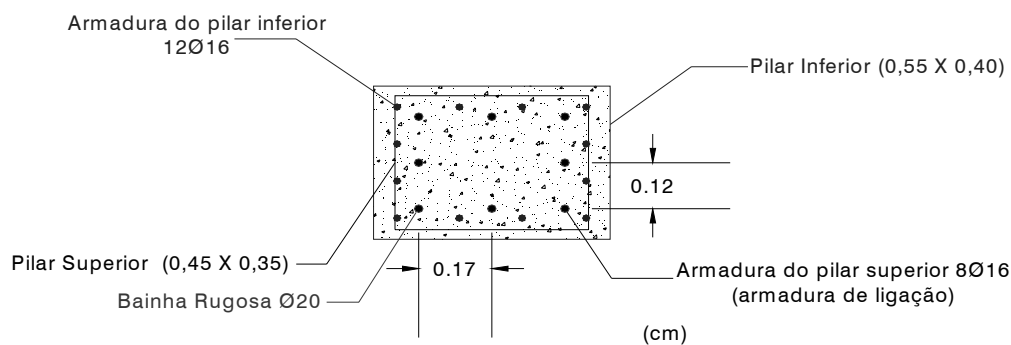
Esquema da sobreposição dos pilares no piso -1 e consequentes armaduras de ligação
